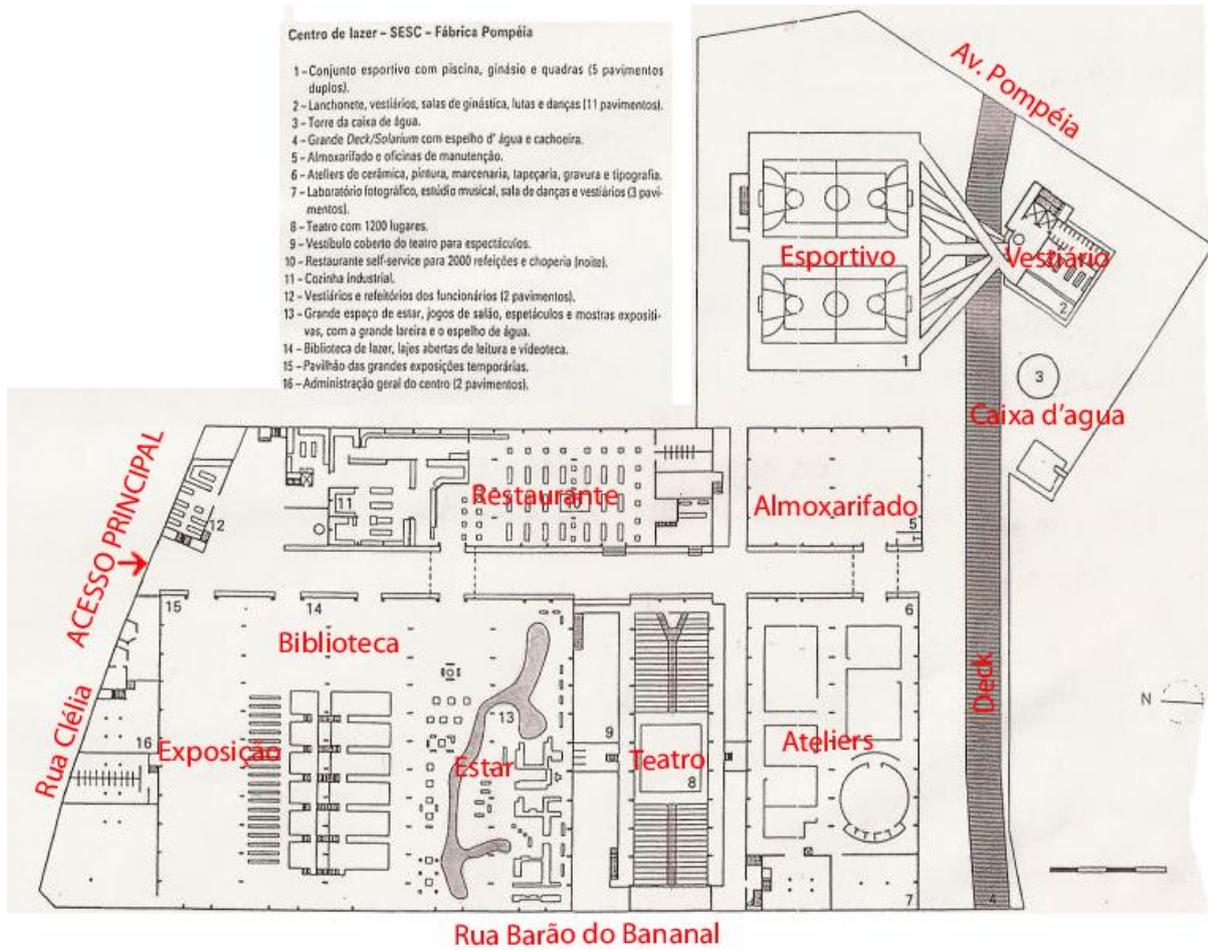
Planta pavimento térreo de todo o complexo.
